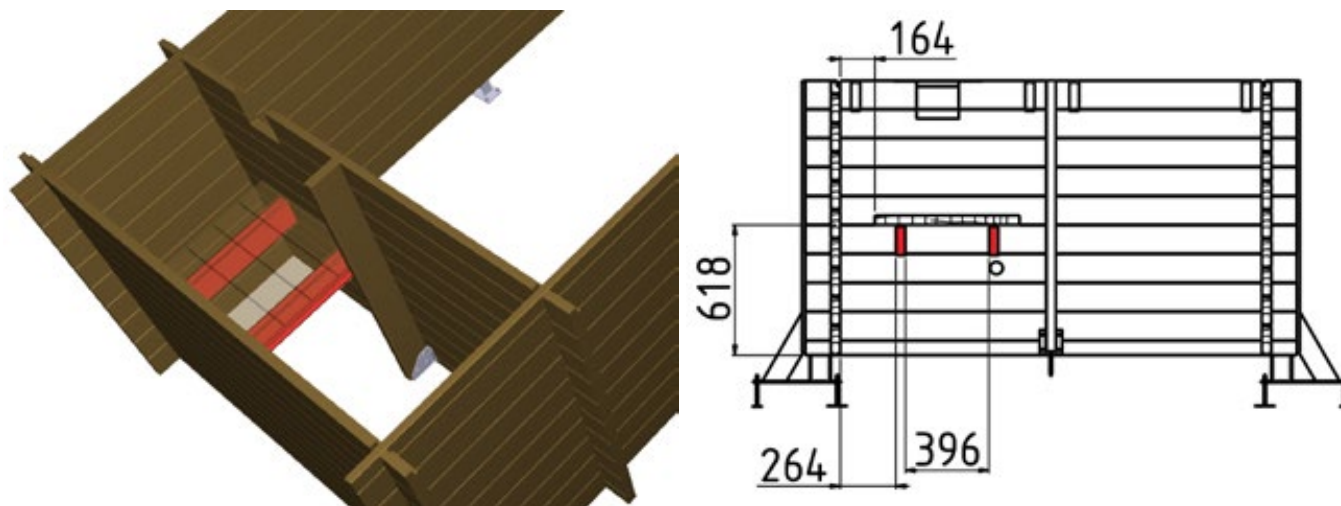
Colocación de los refuerzos de apoyo en el suelo de la caja
